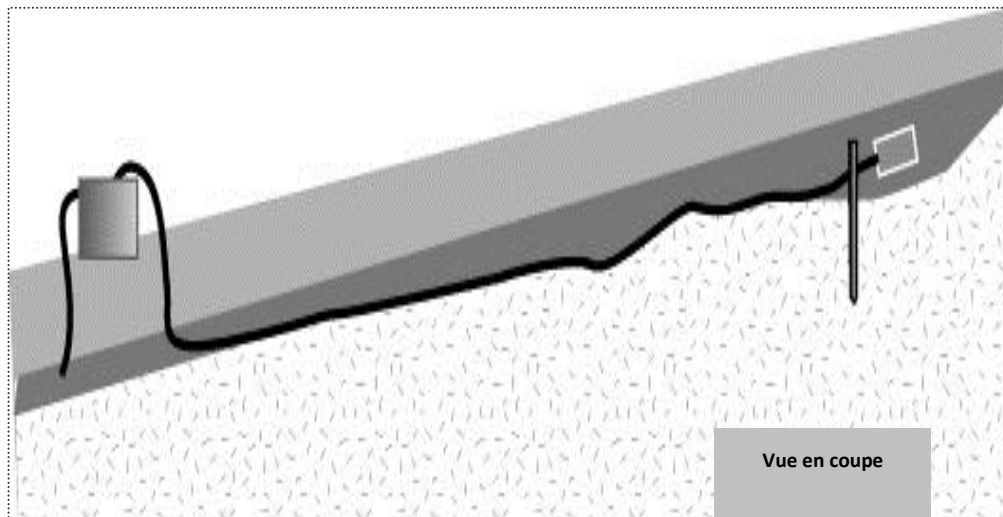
Plan en coupe d'un abreuvoir gravitaire
